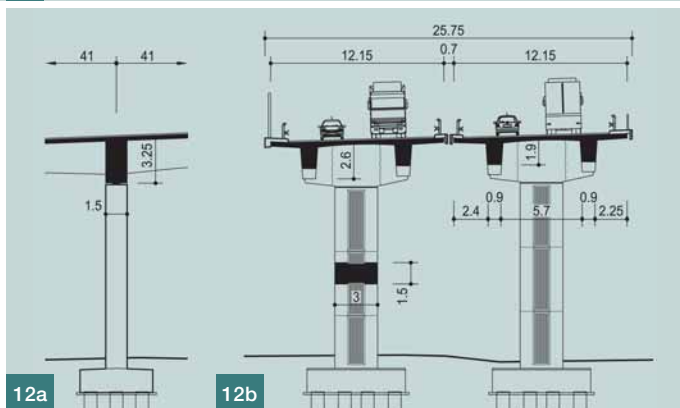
Viadukt R1 214, a) řez podpěrou, b) příčný řez ■ Fig. 12 R1 214 viaduct, a) elevation at pier, b) cross section
